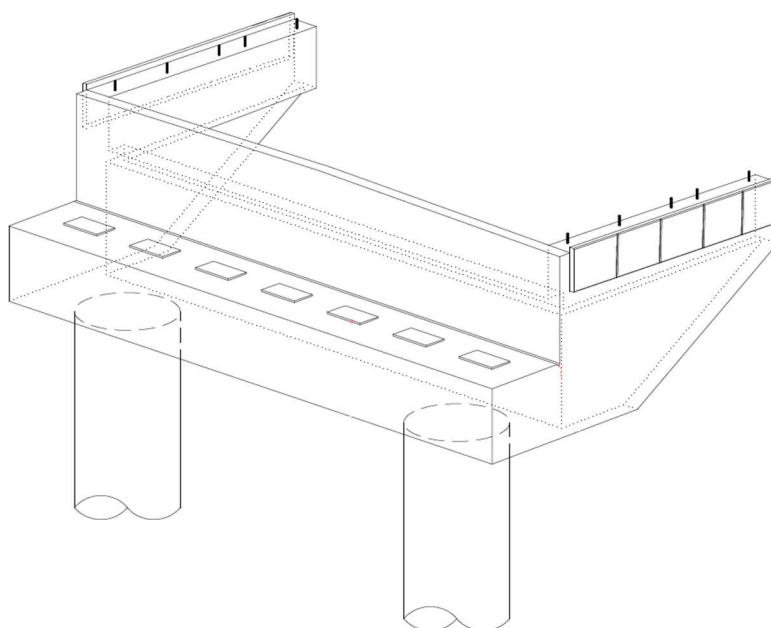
Demonstração do vão de acesso da ponte sobre o Rio Manso.
